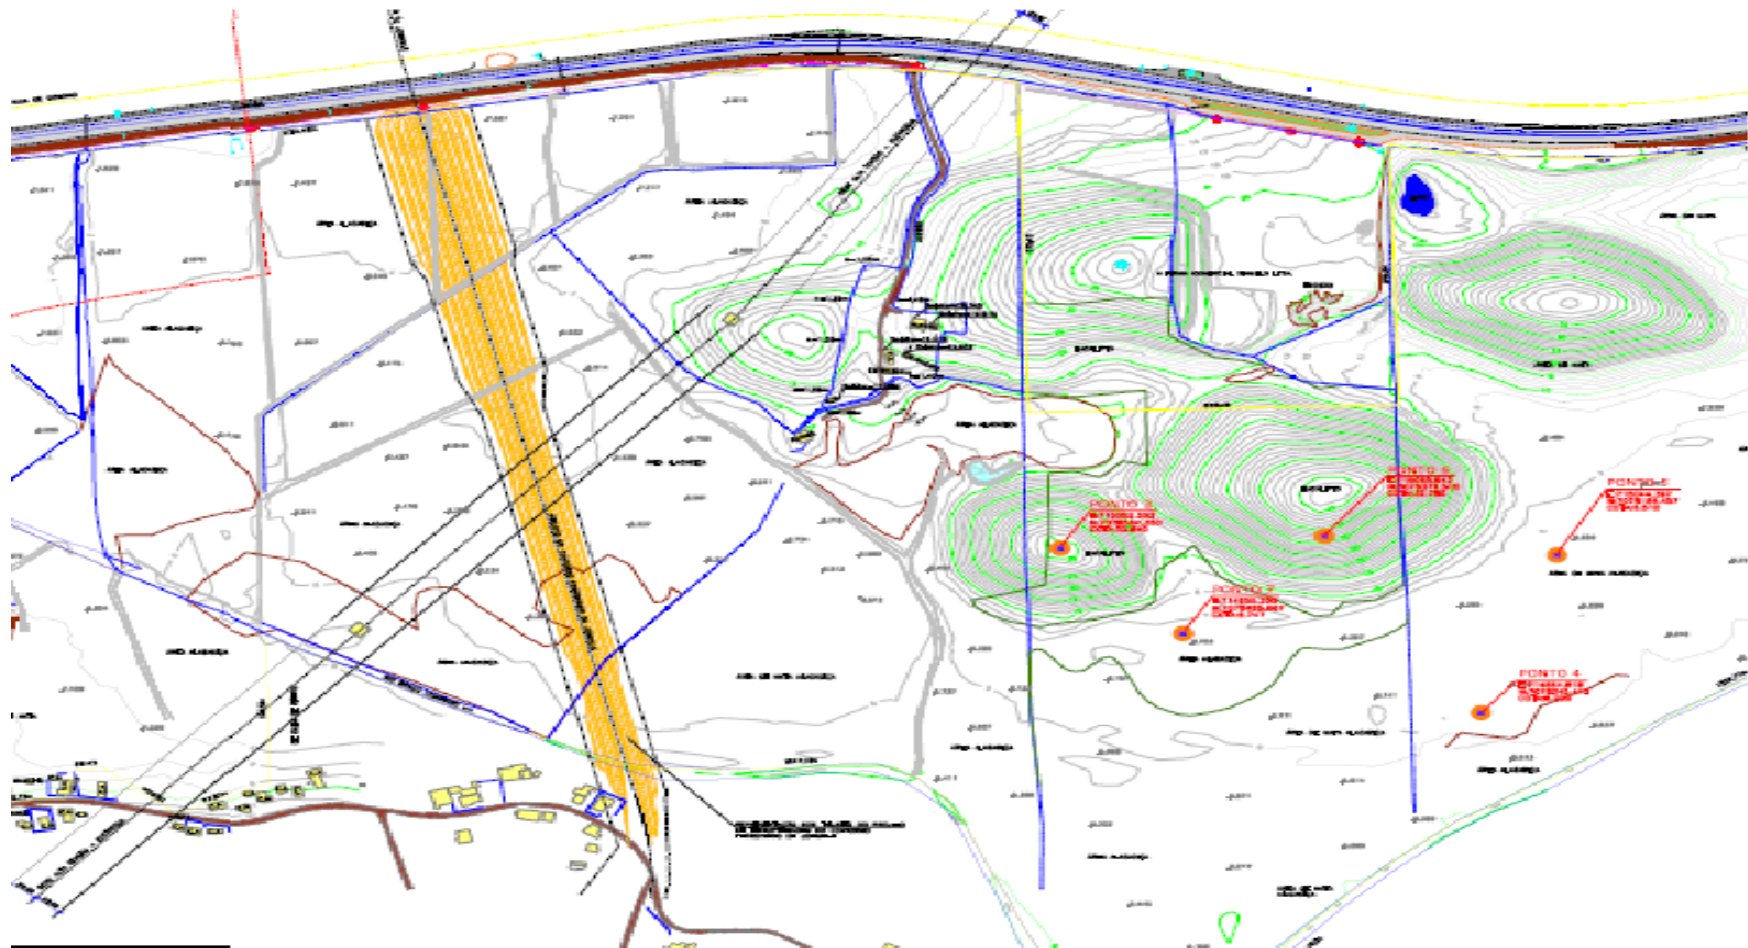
Planta com a localização das sondagens a percussão efetuadas na área do projeto.
